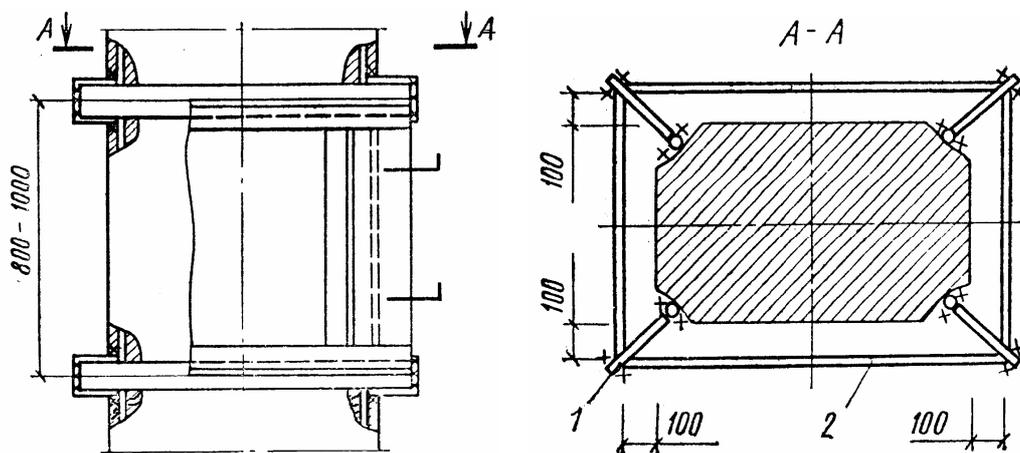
Усиление железобетонной обоймой с использованием щитовой опалубки с креплением к «воротникам»: 1 – пластина; 2 – планка «воротника»
